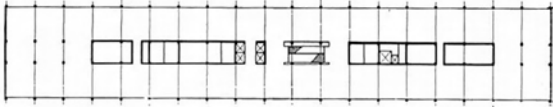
Grundriß vom Ford-Verwaltungsgebäude in Detroit
